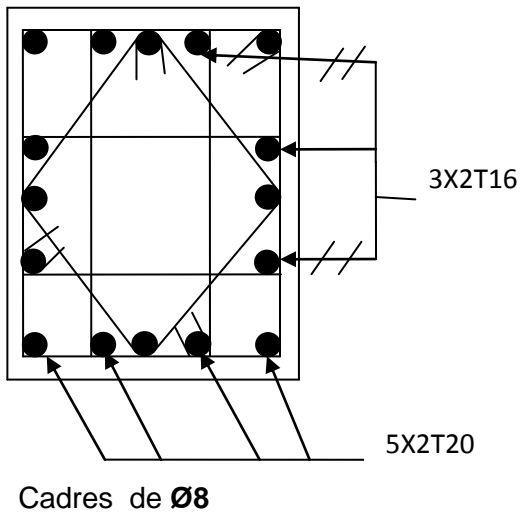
schéma de ferrailage des Poteaux (75x70)
